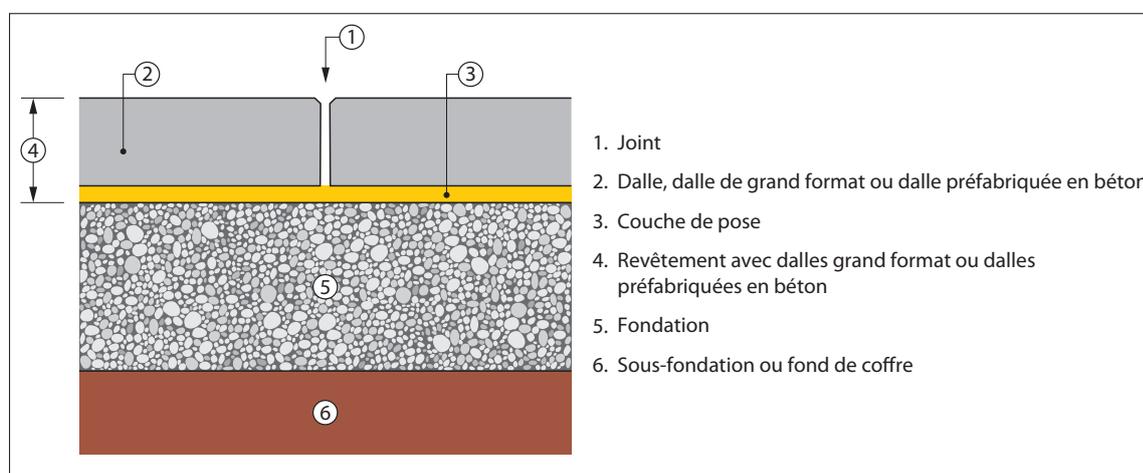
Exemple de structure d'un revêtement en dalles, en dalles de grand format ou en dalles préfabriquées en béton
